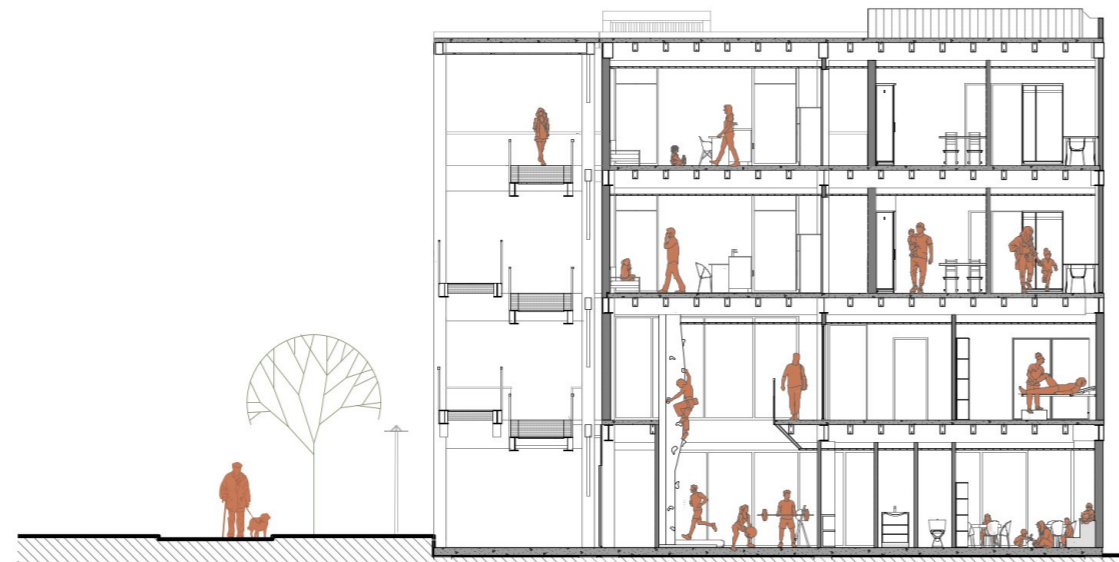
Corte B-B longitudinal bloque. Autoría propia.
